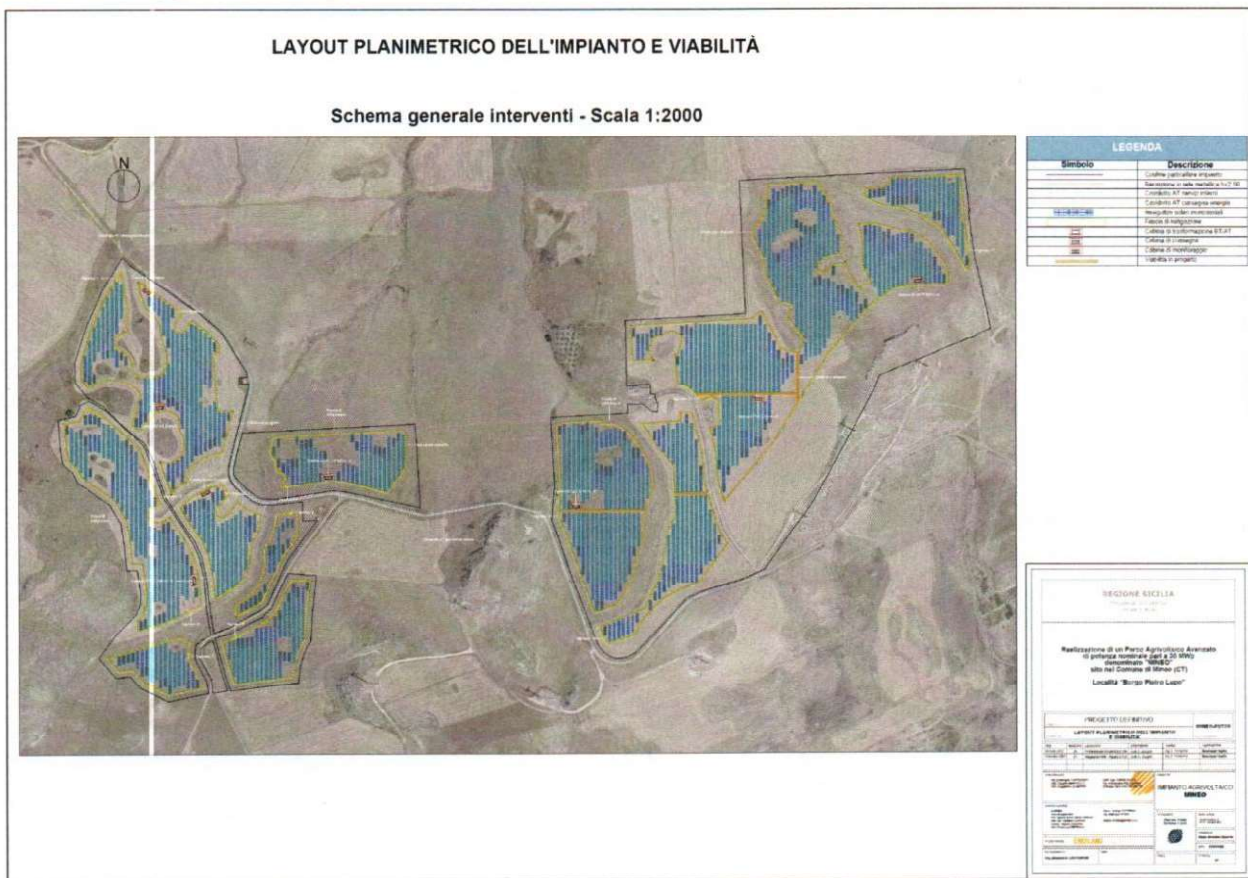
Elaborato integrativo redatto dal proponente – “Layout impianto e viabilità ”
